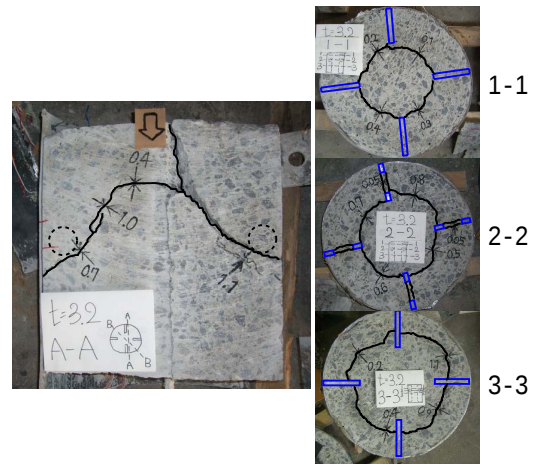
供試体内部のひび割れ (S.C.B100-t3.2-n4-N-T)
